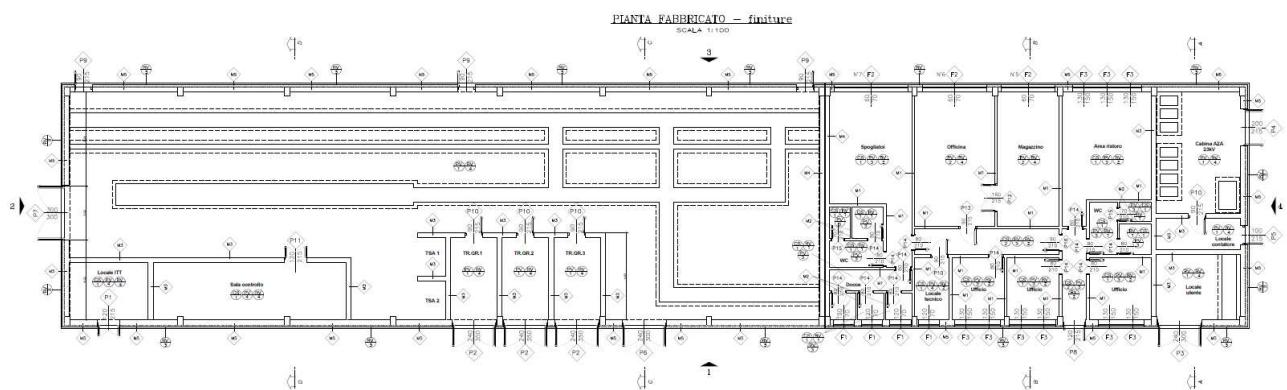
Planimetria SSE con indicazioni murature e finiture
